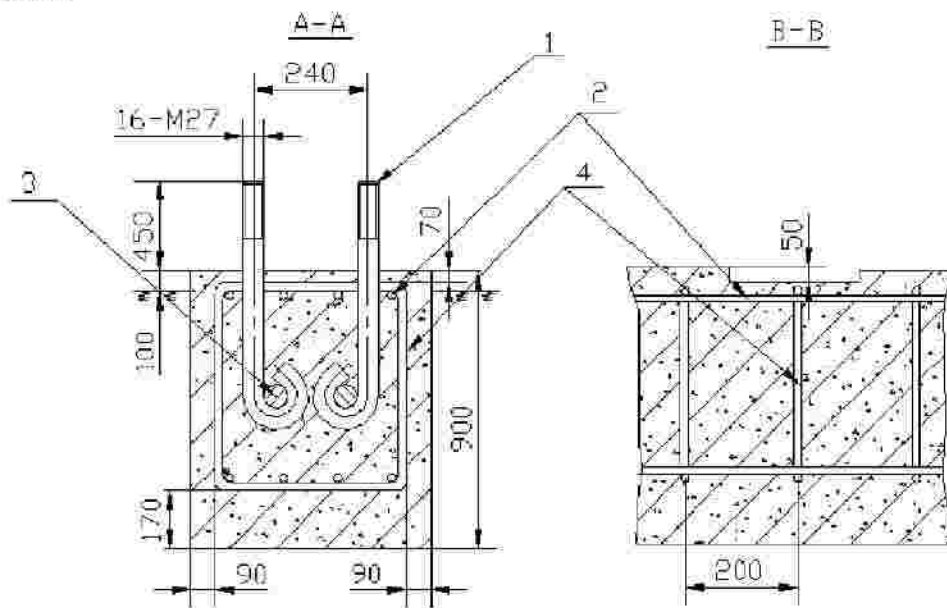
Устройство фундамента для установки башенного крана QTZ 80 на крестовине с анкерным креплением
